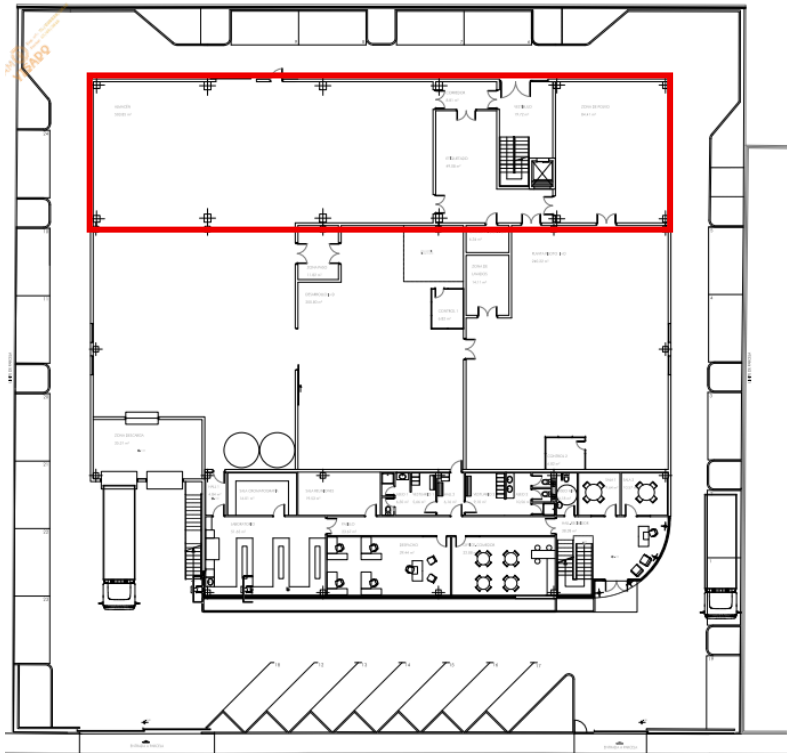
Planta baja estado ampliado. Fuente: Arhotek
